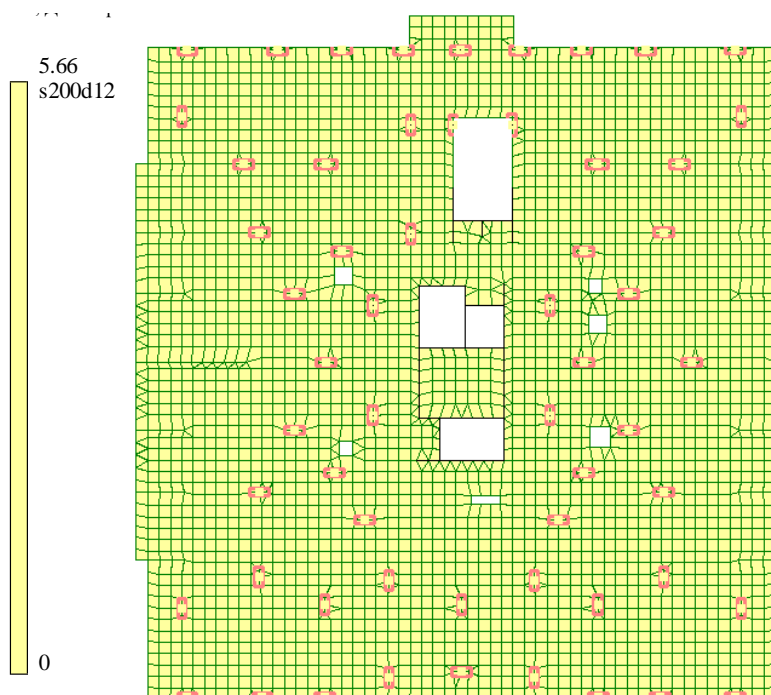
Площадь арматуры на 1 п.м. по оси Y у нижней грани
